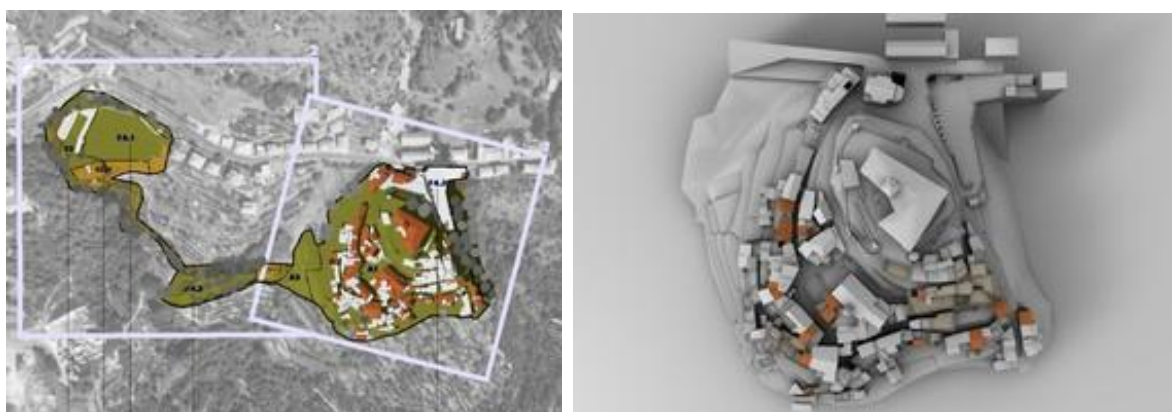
5 Planimetria d'insieme dell'ambito di recupero del Borgo e Rendering planimetrico del Borgo.
